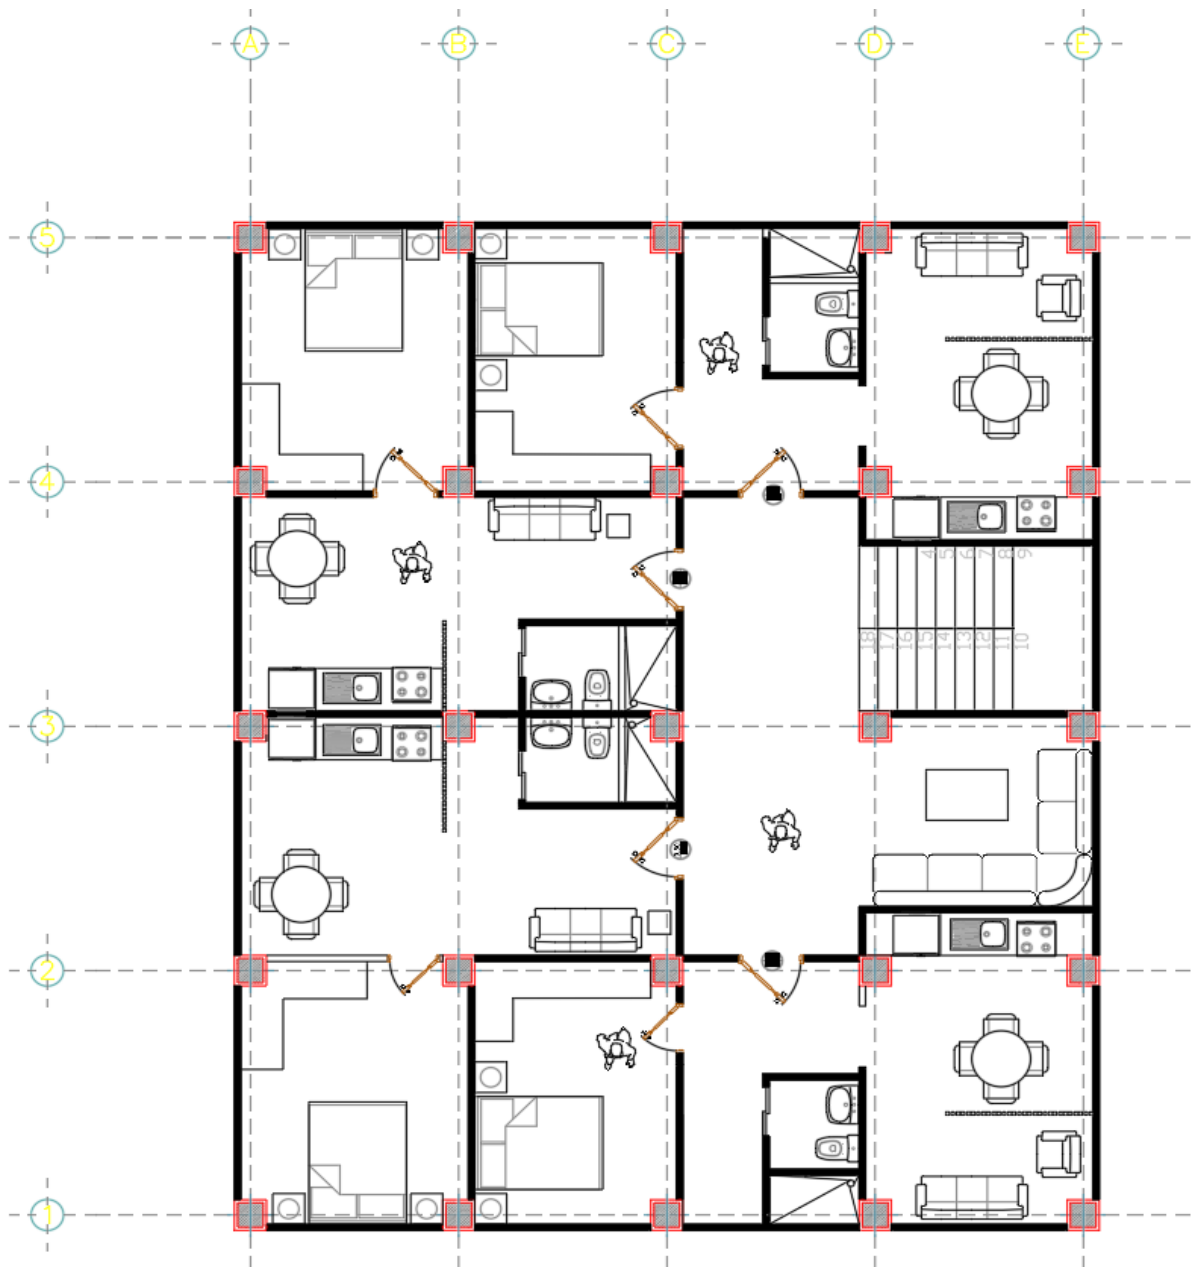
Diseño arquitectónico de la planta alta. Fuente: Propia
